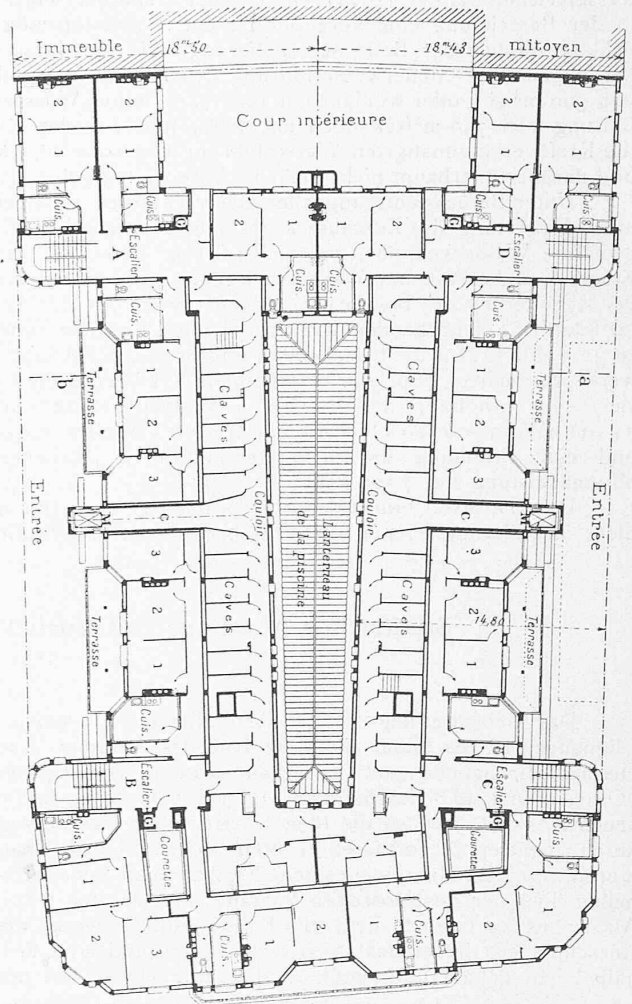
Grundriss. — Masstab 1 : 400.
